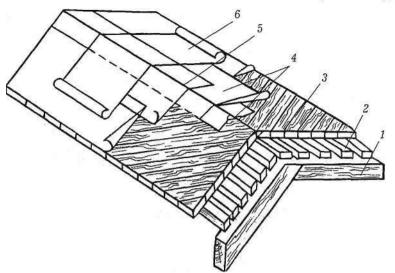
Способы укладки мягкого рулонного кровельного покрытия: 1 - затяжка; 2 — обрешетка; 3 — настил; 4 — нижний слой мягкой кровли; 5 — промежуточный слой кровельного покрытия (пергамин); 6 — верхний слой рулонного покрытия
